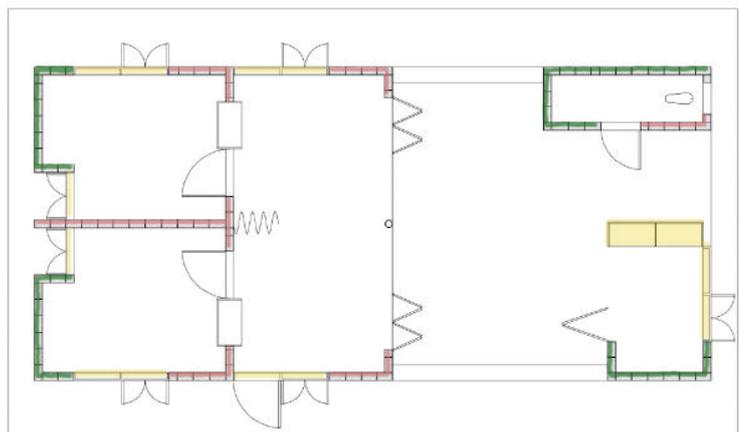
Planta viviendas en Kirinda, Sri Lanka.
